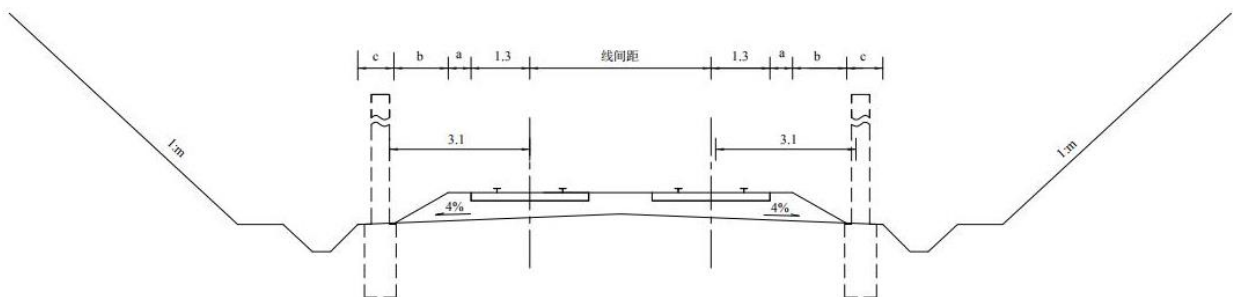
有砟轨道双线硬质岩路堑横断面图 (单位: m)
